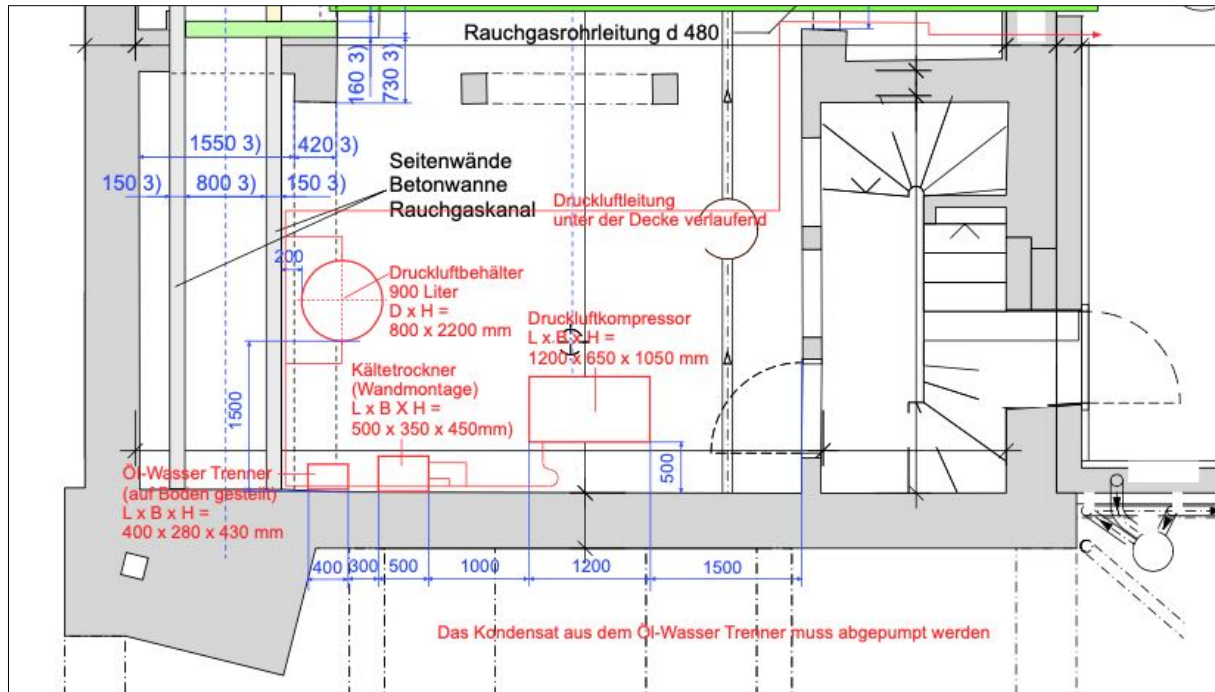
Grundriss Untergeschoss mit Installationen neue Druckluftanlage
